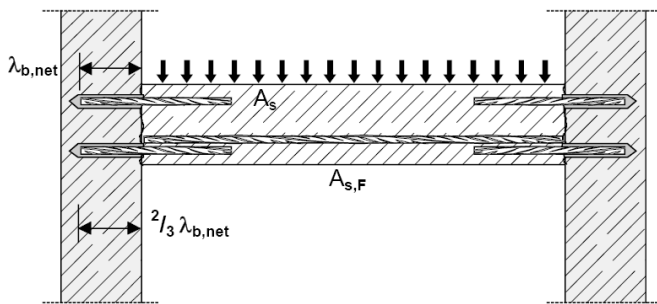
Jonction à recouvrement de barres d'armature de dalles et poutres
